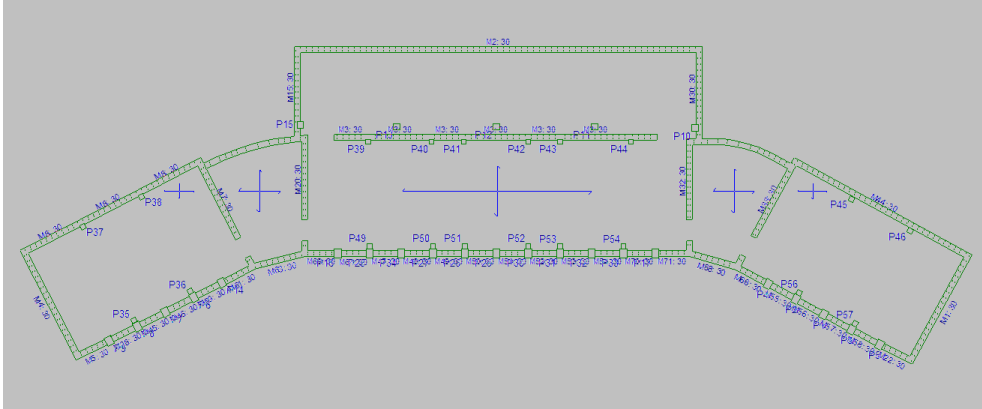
Planta cubierta del modelo de 1 planta
